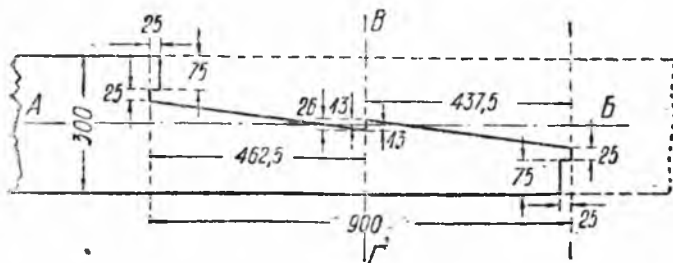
Чертеж затяжного зуба. Вид сбоку.
